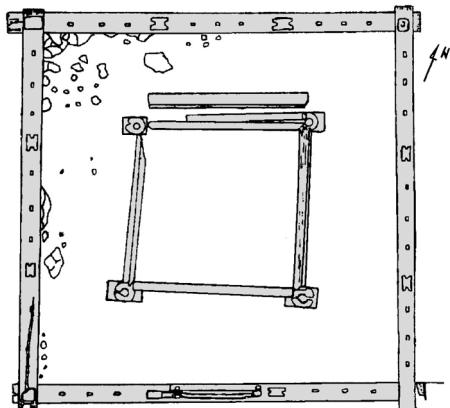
Grundriss des Tempels Niya (aus Zhang 1998: 7).
